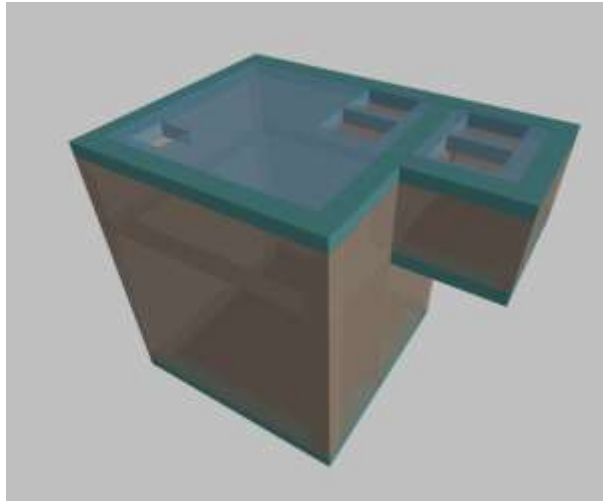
Pozo de bombeo pluviales, Alternativa 1 y Alternativa 2.
